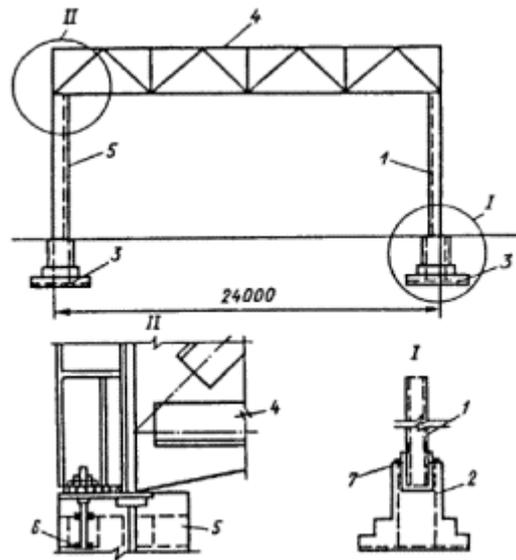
Молниезащита здания II категории с металлическими фермами (в качестве токоотводов и заземлителей использована арматура железобетонных колонн и фундаментов):
